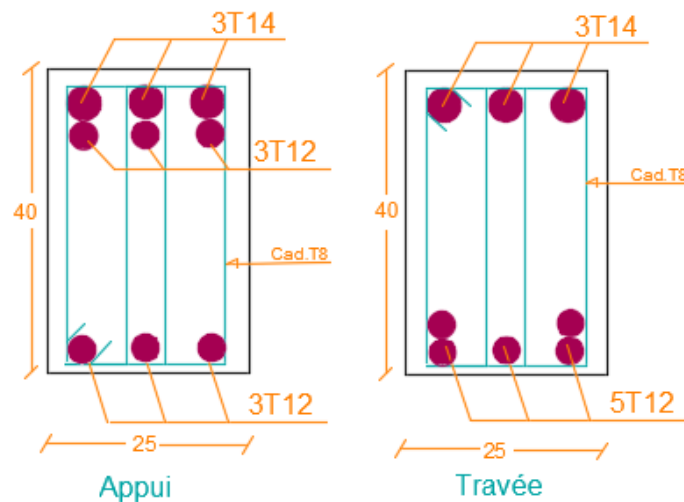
Ferrailage Des Poutres De chaînage Du Niveau Terrasse et E-C.
